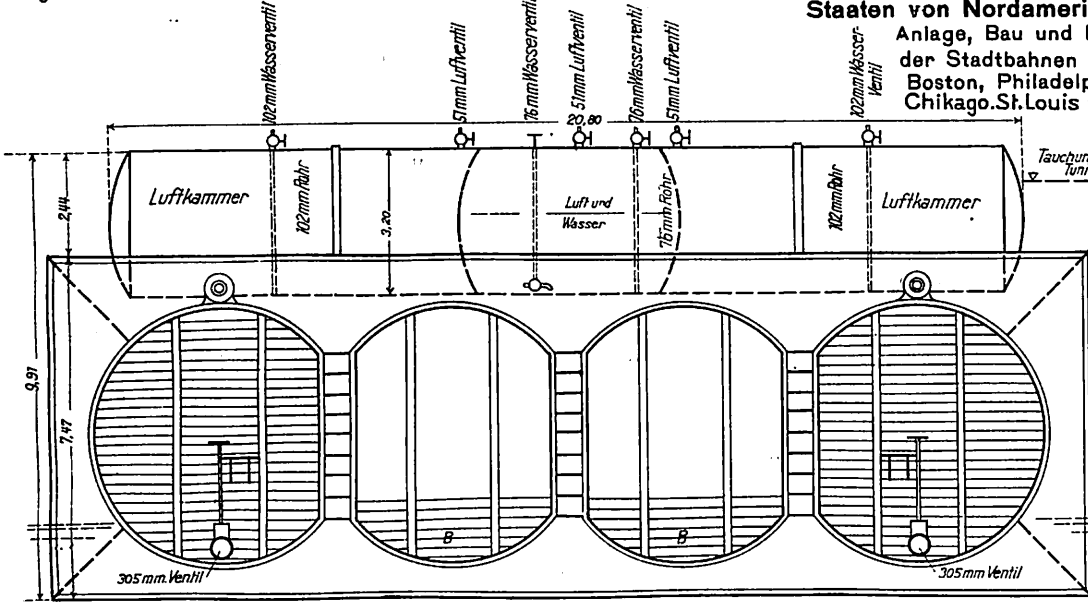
Ansicht eines schwimmfähigen Tunnelstückes des viergleisigen Tunnels unter dem Harlem-Flusse der Untergrundbahn in der Lexington-Avenue. Maßstab 1:170.
